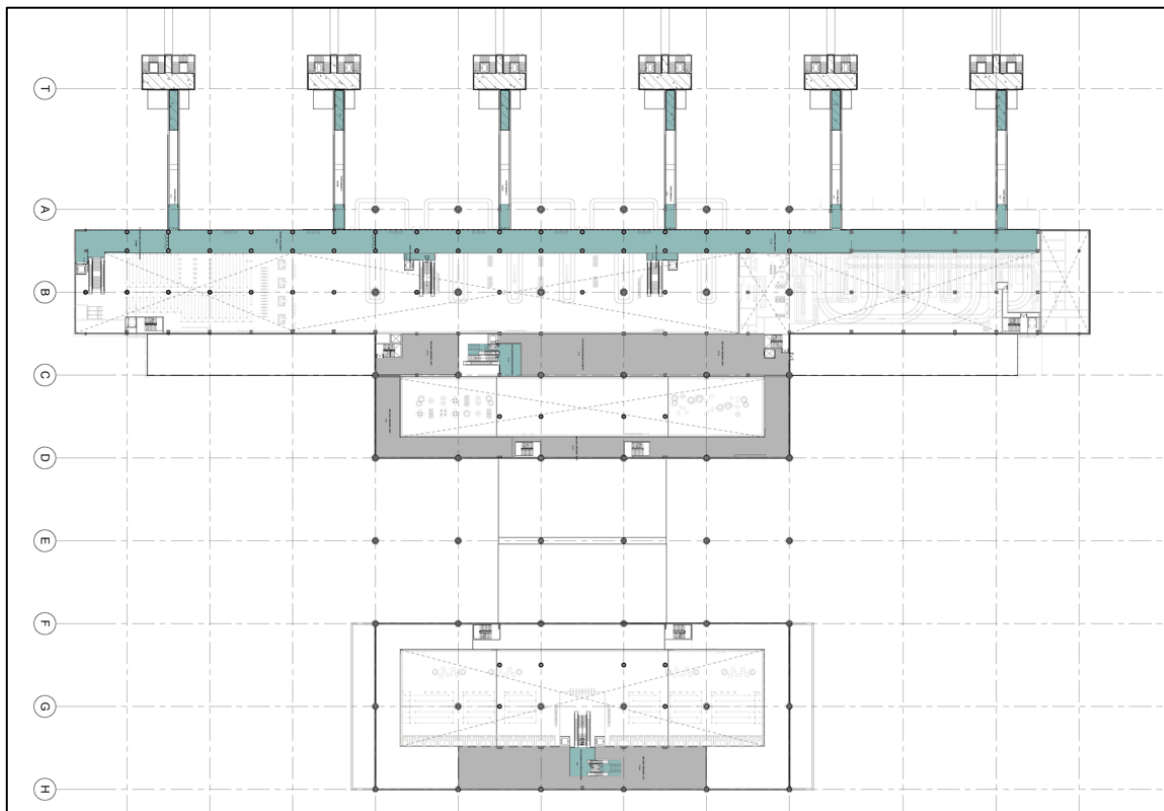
| Planimetria Piano Mezzanino 2035– Zoning delle aree
